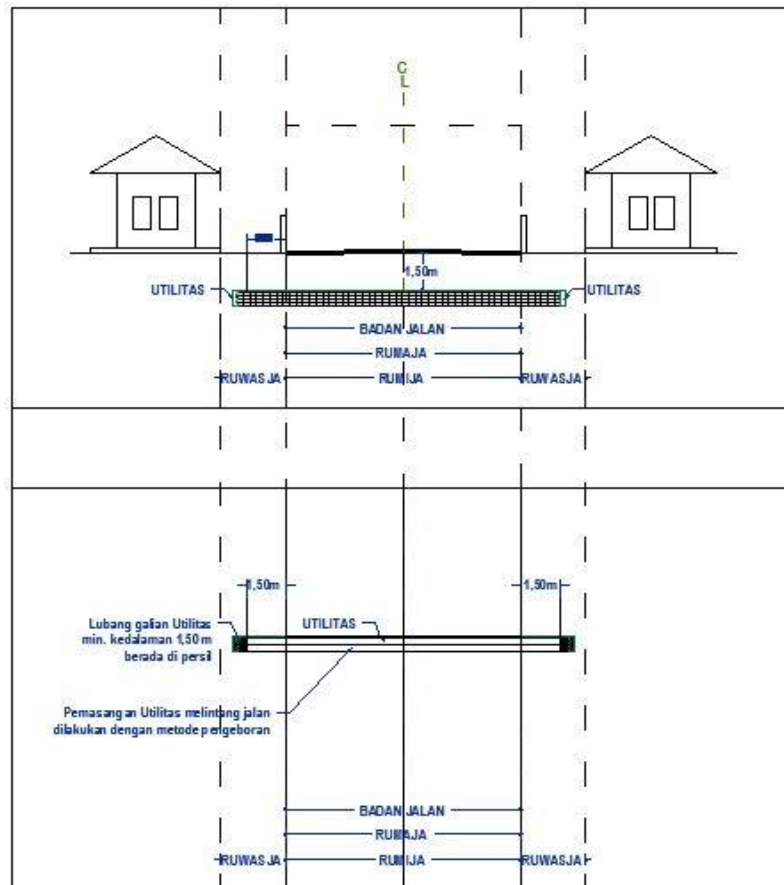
Alternatif 1 Penempatan Bangunan dan Jaringan Utilitas di Bawah Tanah di Ruang Milik Jalan Tipe 5
